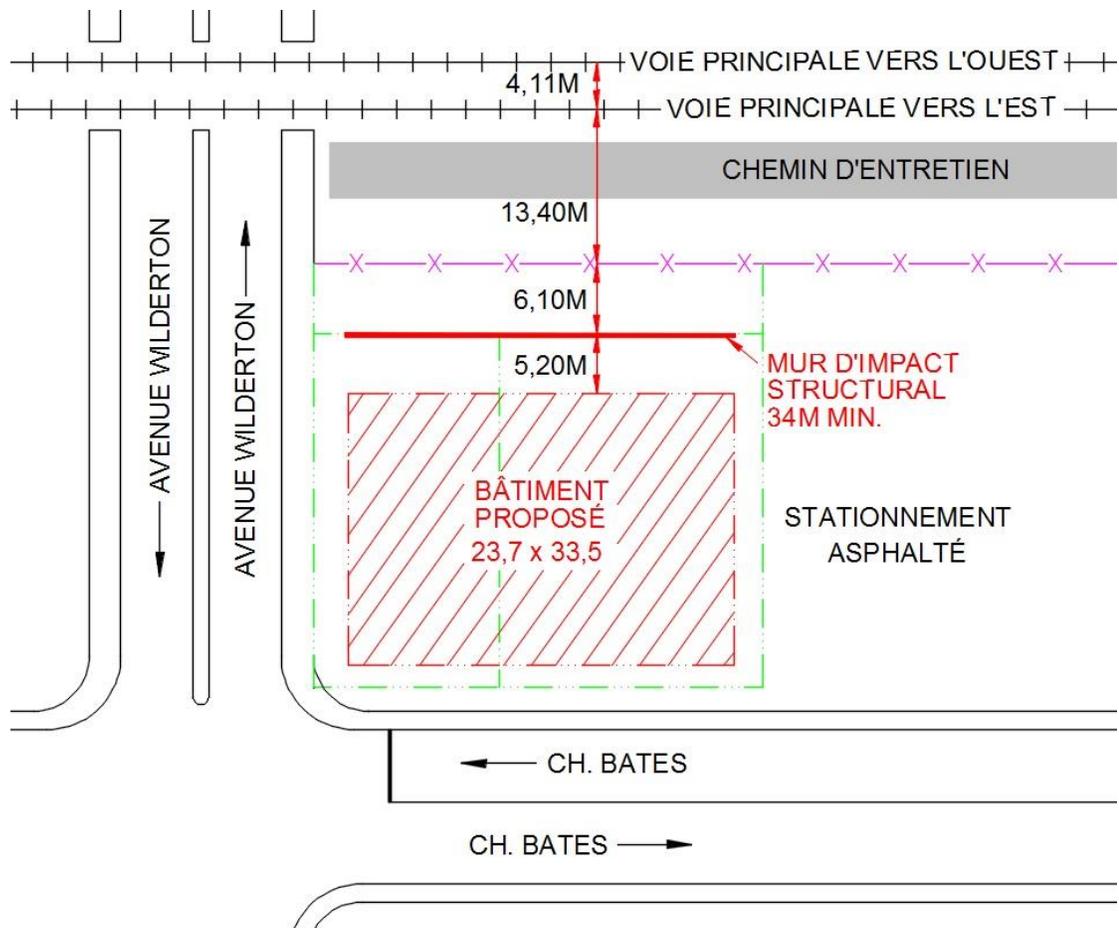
Plan d'ensemble du site proposé au PM 48.82 ADIR.
